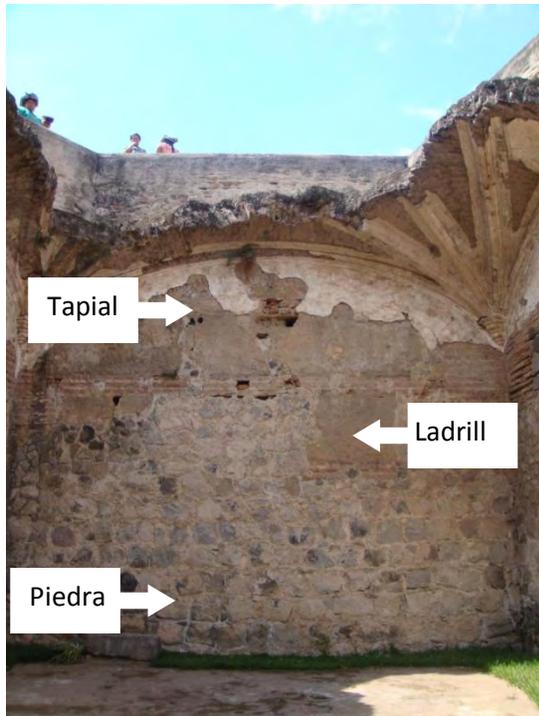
Muro ubicado en el Convento de San Francisco, se indican los materiales utilizados para su construcción.
